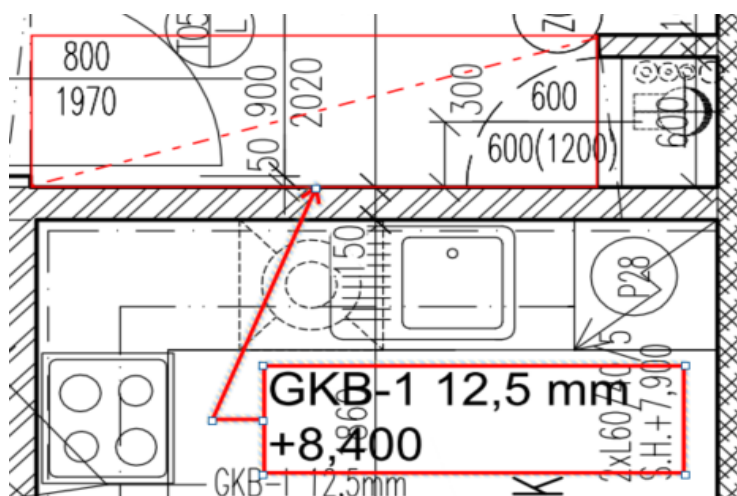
Vyvedení VZT potrubí mimo stoupačí šachtu
